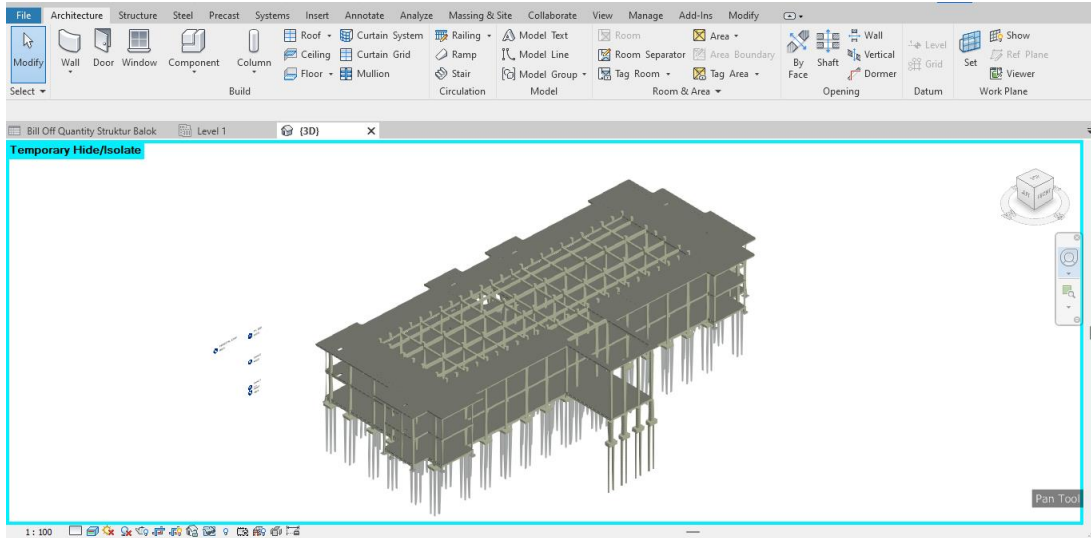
Tampilan Memasukkan Struktur Kolom Kedalam Permodelan
